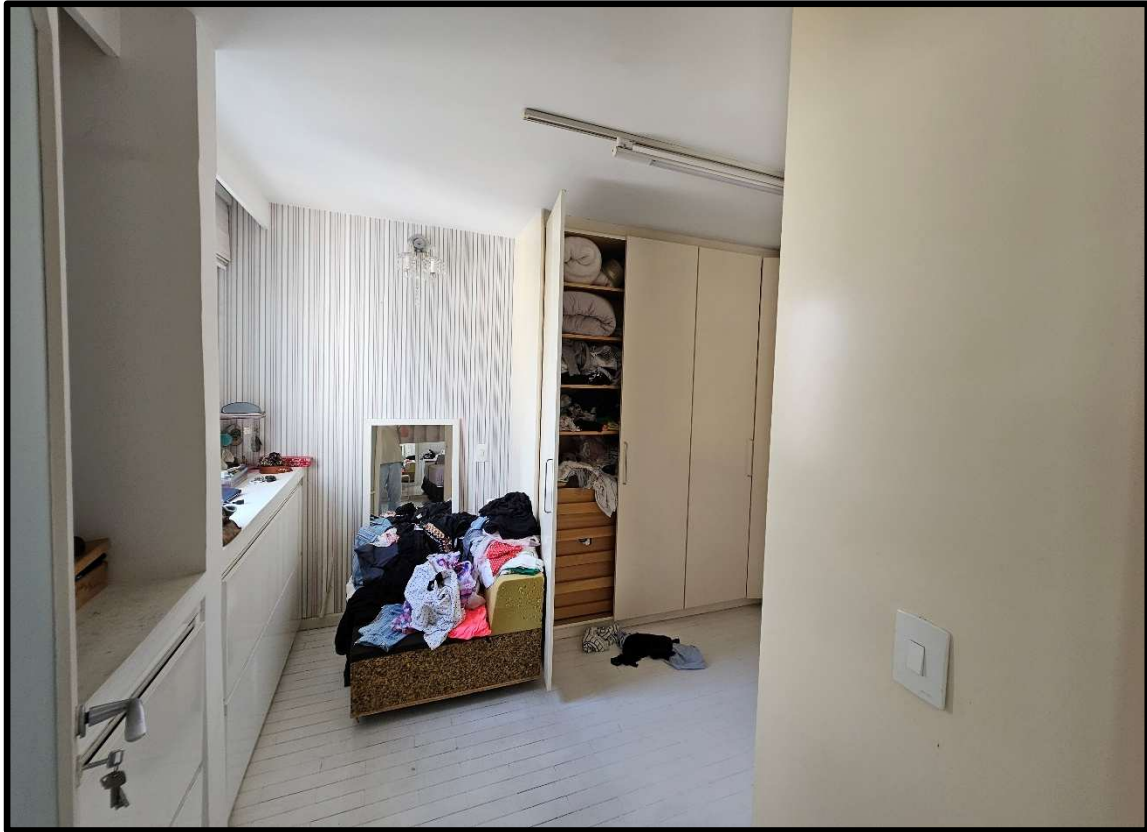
Closet - 1ª Suíte (1º Pavimento)
